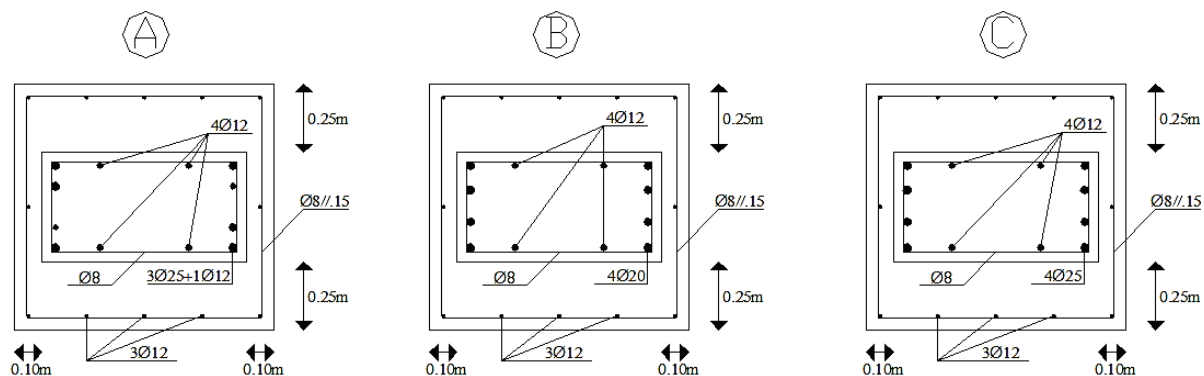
Secção transversal dos pilares do R/C do edifício Lisboa após reforço através da técnica de encamisamento de pilares.
